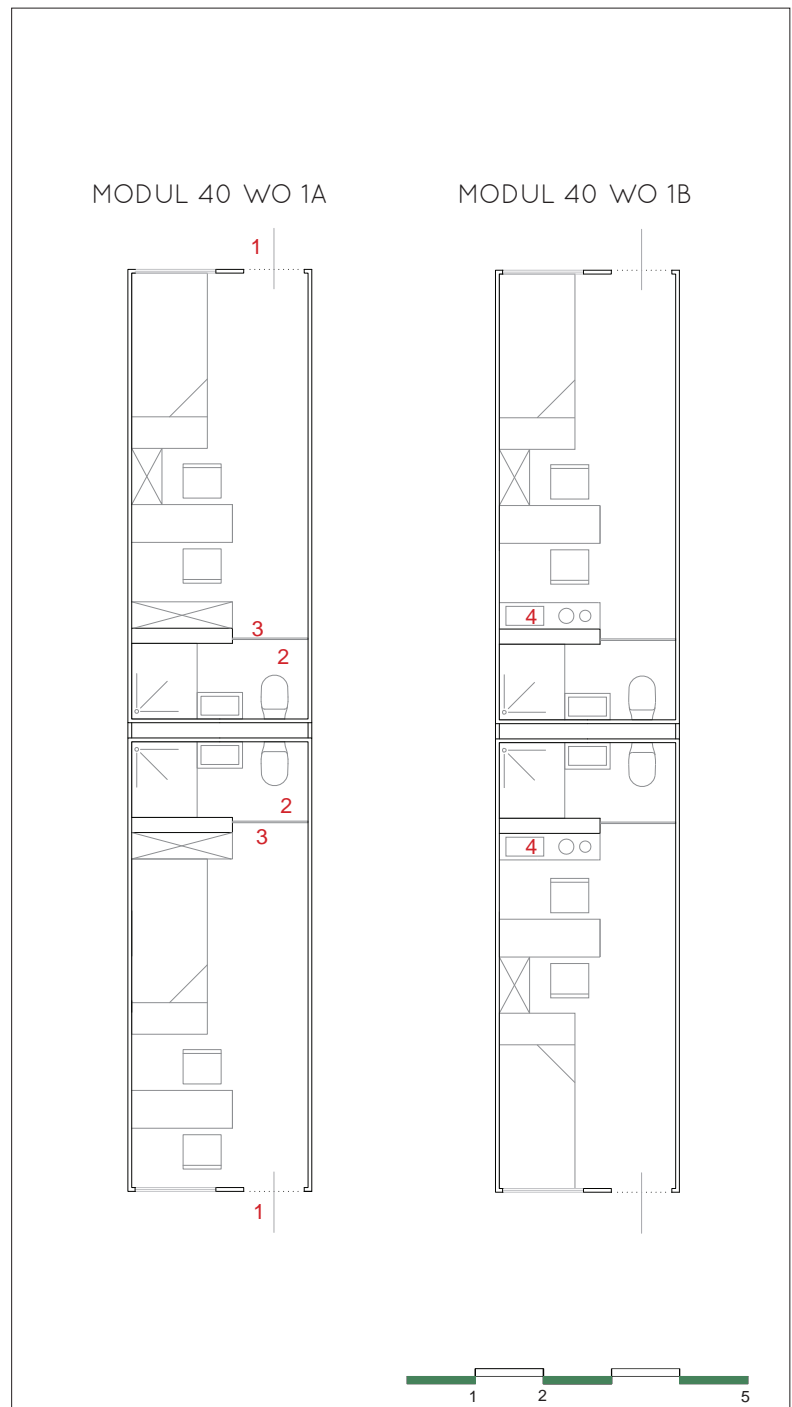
Grundriss Modul 40 WO 1A und 1B
